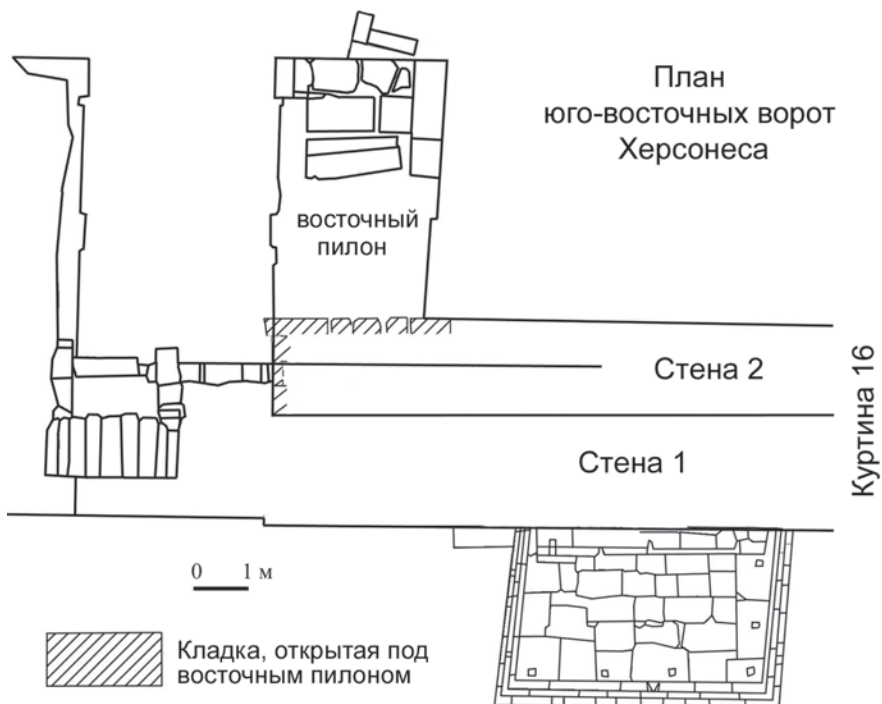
План кладки в основании восточного пилона ворот (2009 г.).
